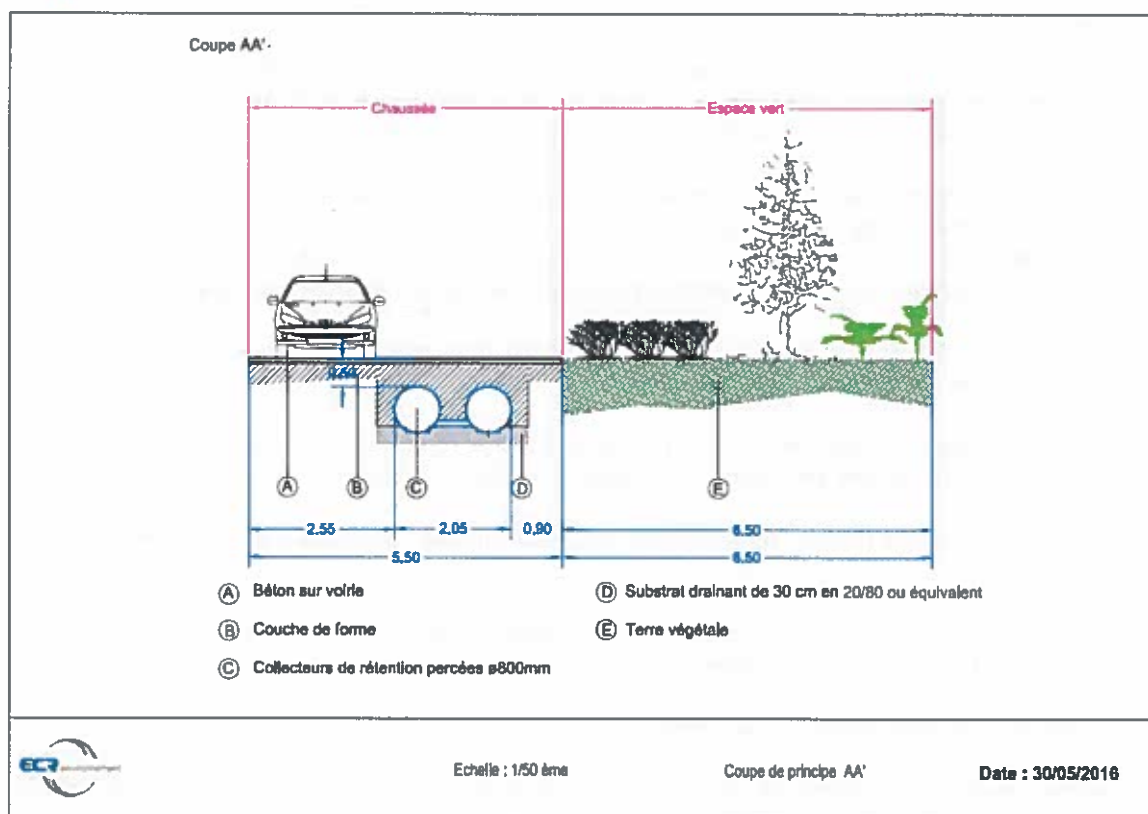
Coupe type d'un ouvrage de rétention sous-voirie
